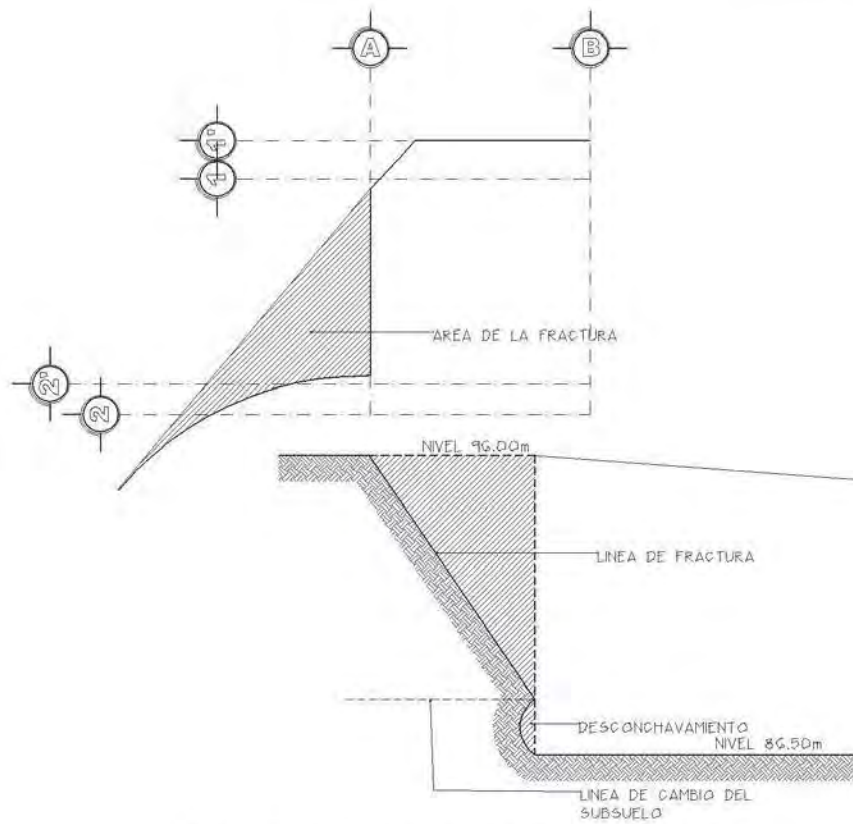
Ubicación y corte de la zona de fractura
